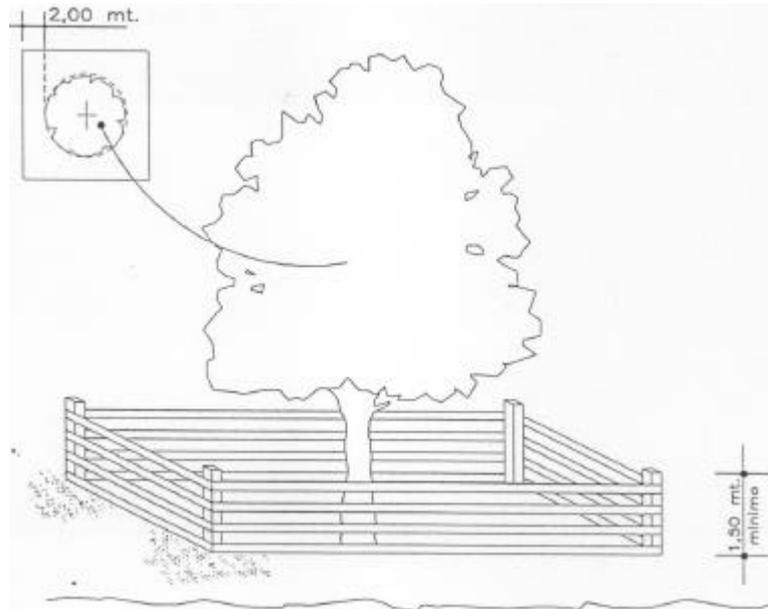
Protezione dell'albero attraverso la delimitazione dell'area minima di rispetto in aree parco
